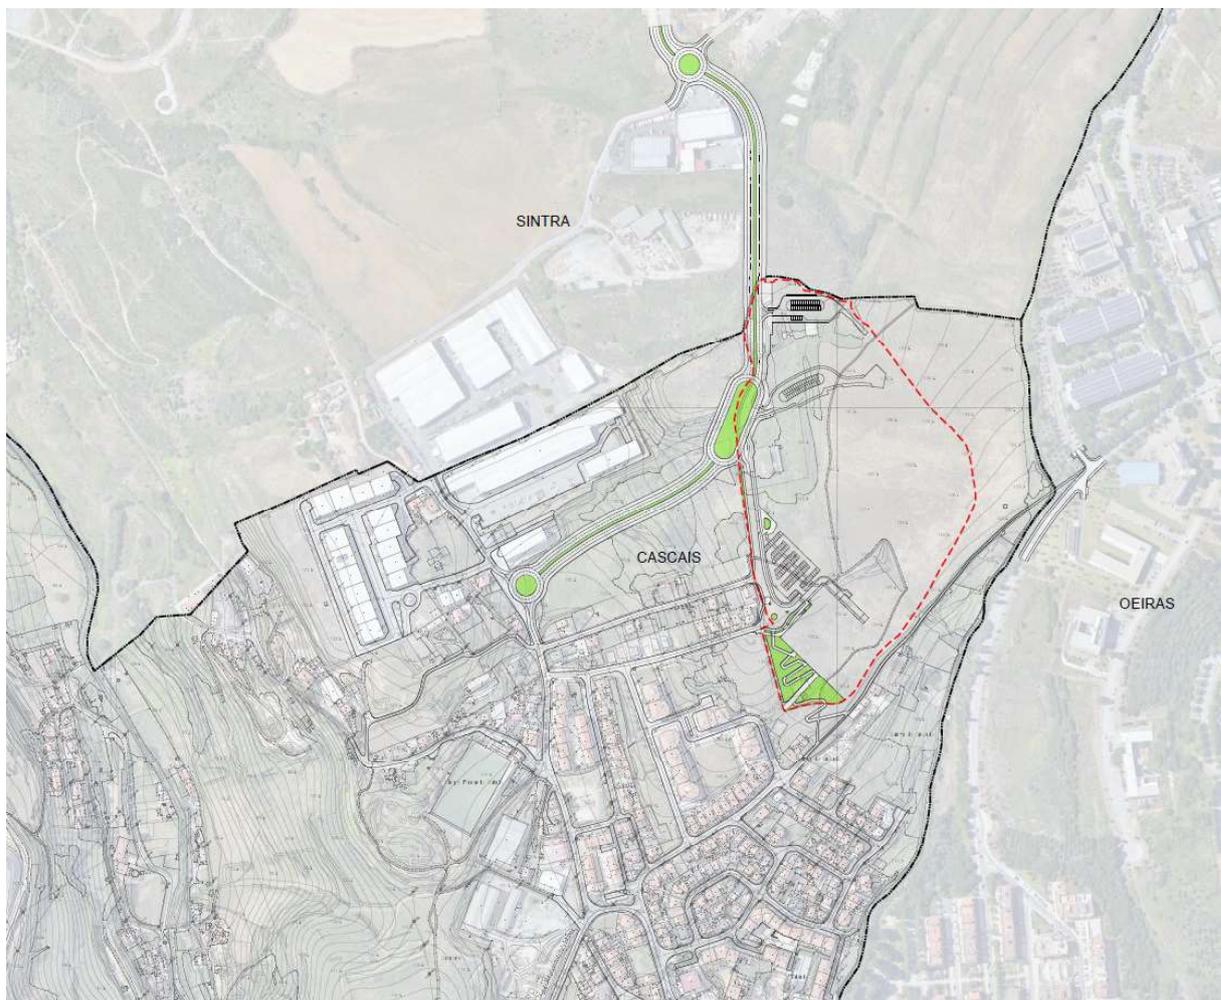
Extrato da Planta da Área de Influência (AutoCad).
